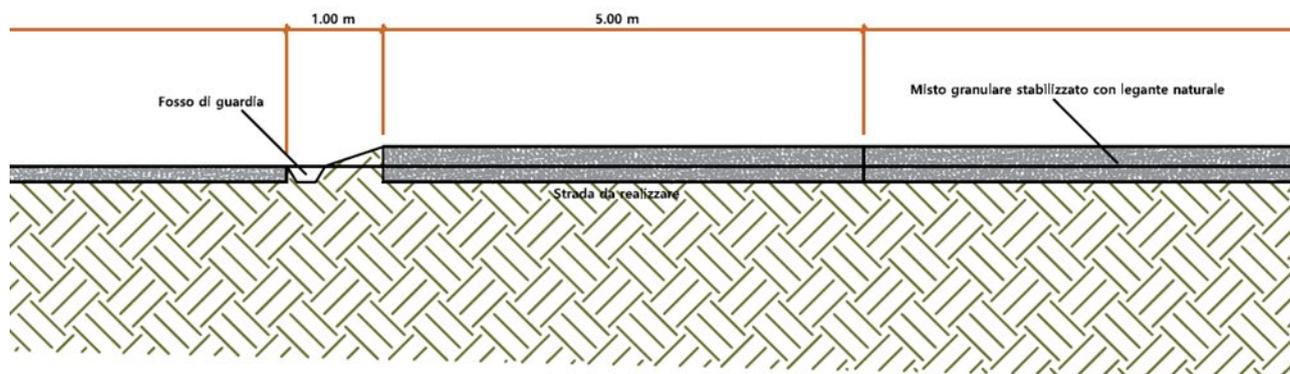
esempio di sistema di drenaggio a bordo strada in sezione
